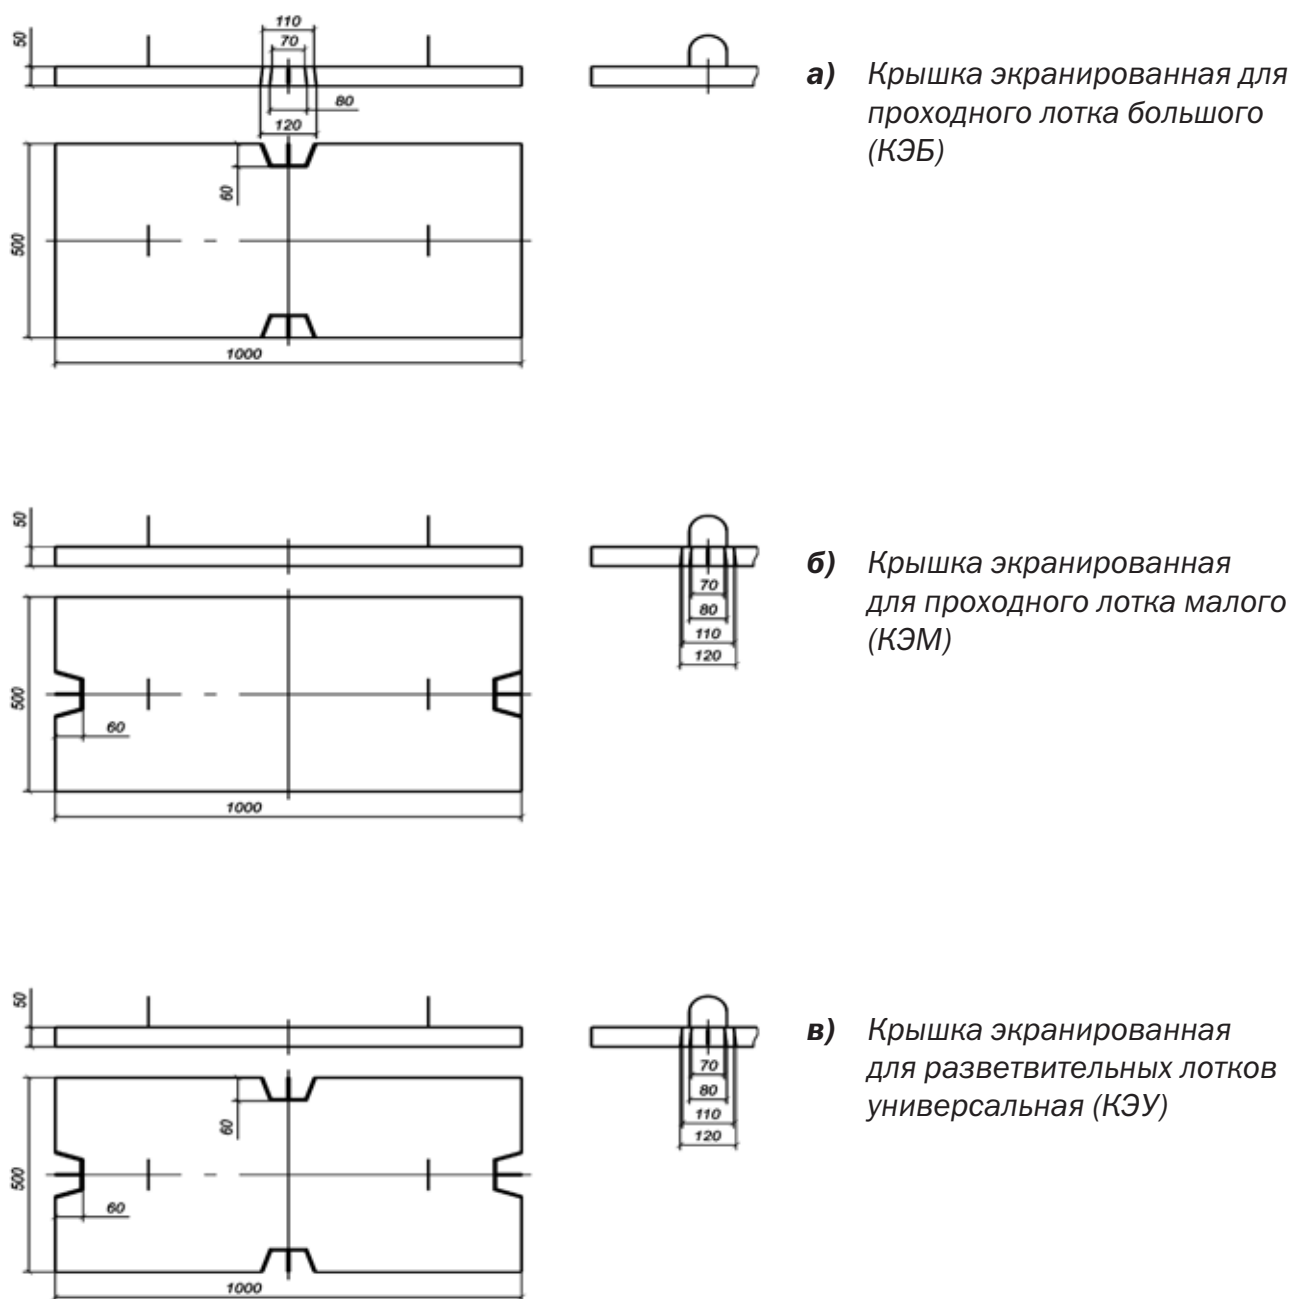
Железобетонные крышки для экранированных лотков.
